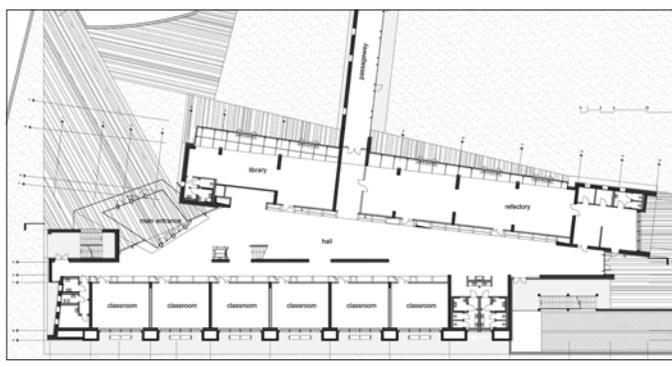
, 109: pianta schematica piano terra e pianta generale. (Fonte: AGIBILE E BELLA, inarch.it)
